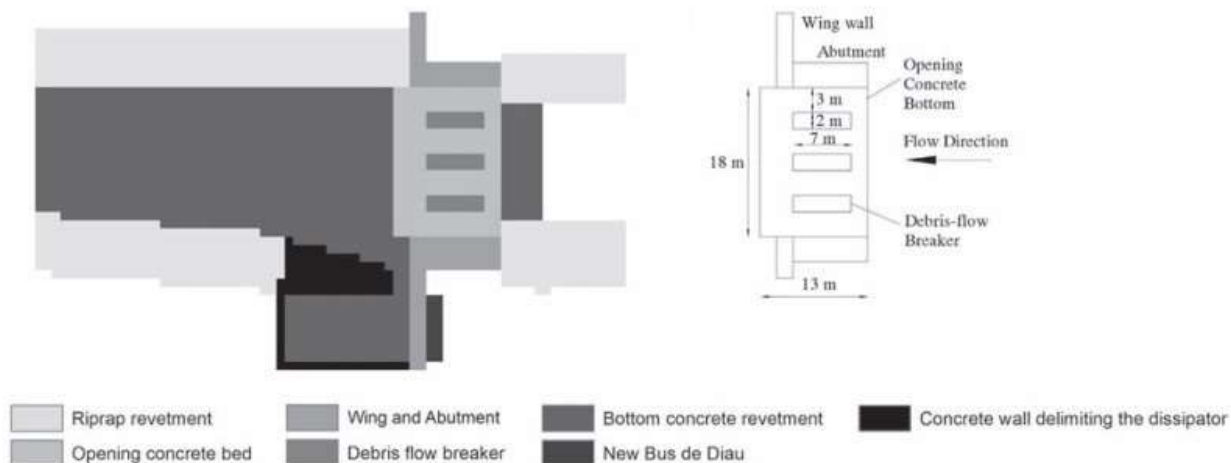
Planimetria di progetto della briglia frangicolato (Bernard et al, 2019)
